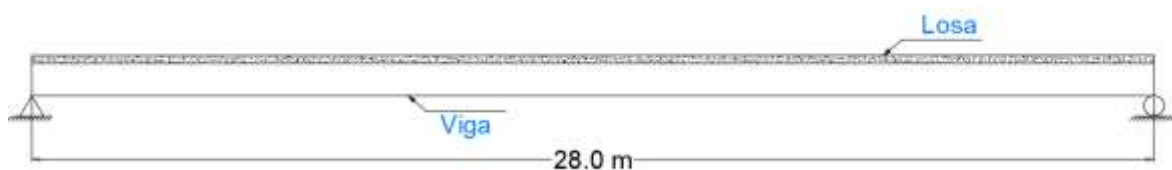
Perfil longitudinal del puente con vigas de hormigón postensadas
